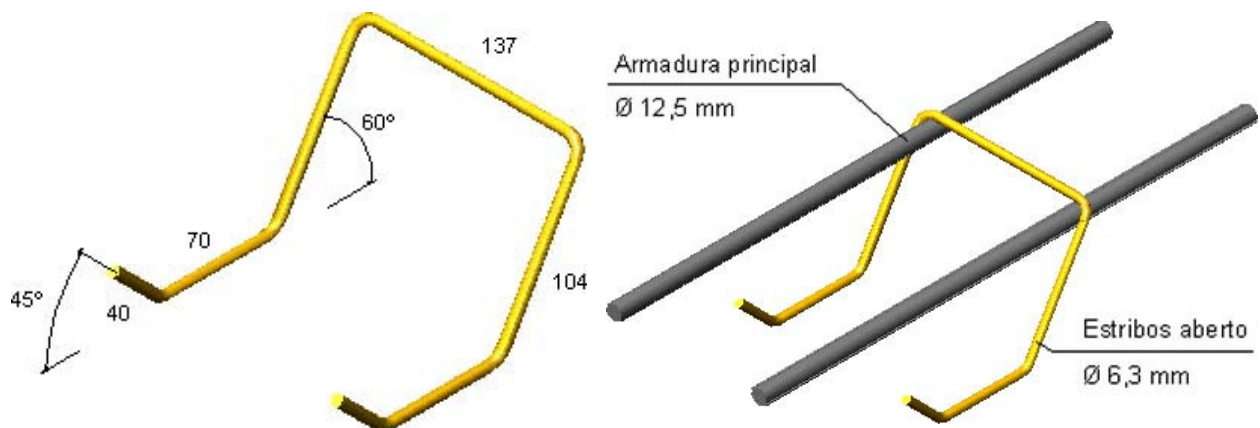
Armadura de cisalhamento do tipo estribo aberto e inclinado
